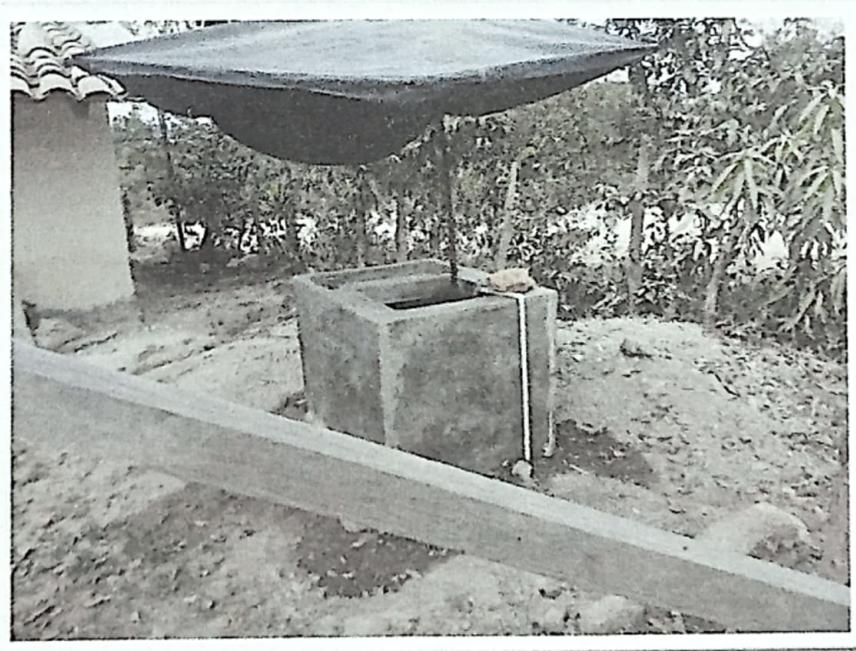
CONSTRUCCION DE PILA CON RIBAL
